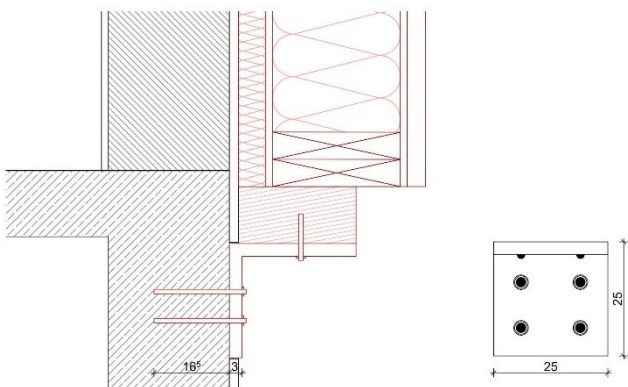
Stahlwinkel mit Sockelbereich mit Auflagerung oben
